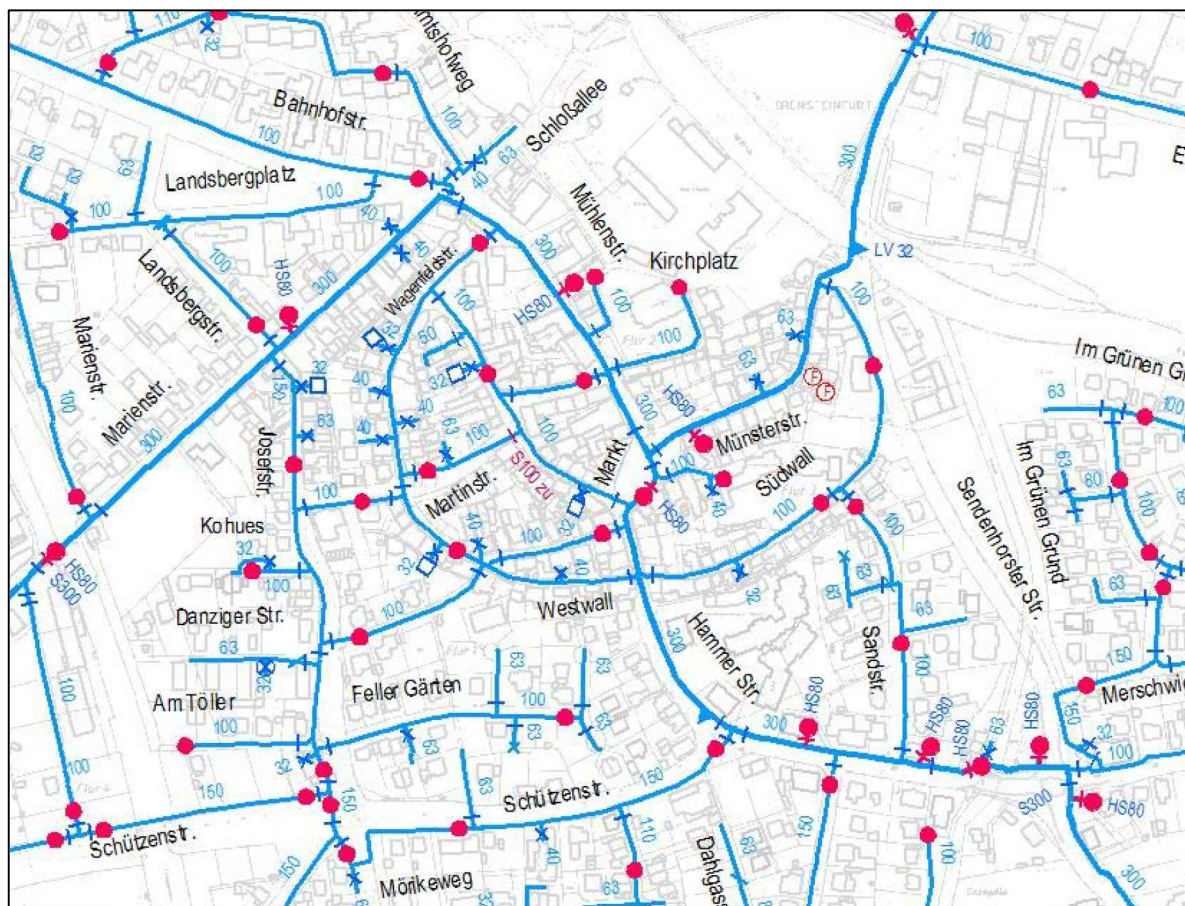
Ausschnitt Hydranten-Plan in Drensteinfurt (rote Punkte: Hydranten)
